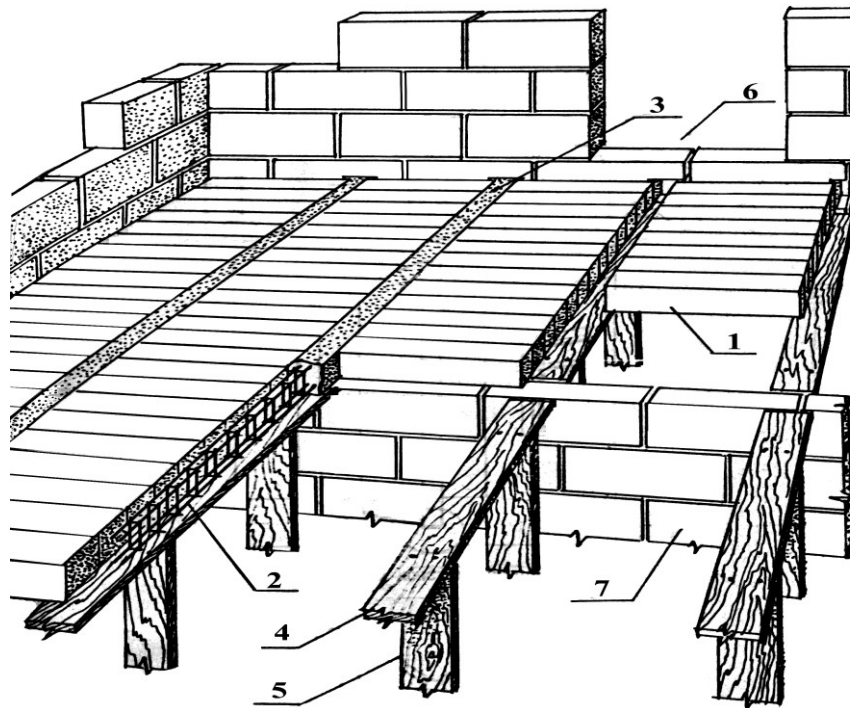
Сборно-монолитное перекрытие из мелких газобетонных блоков:
